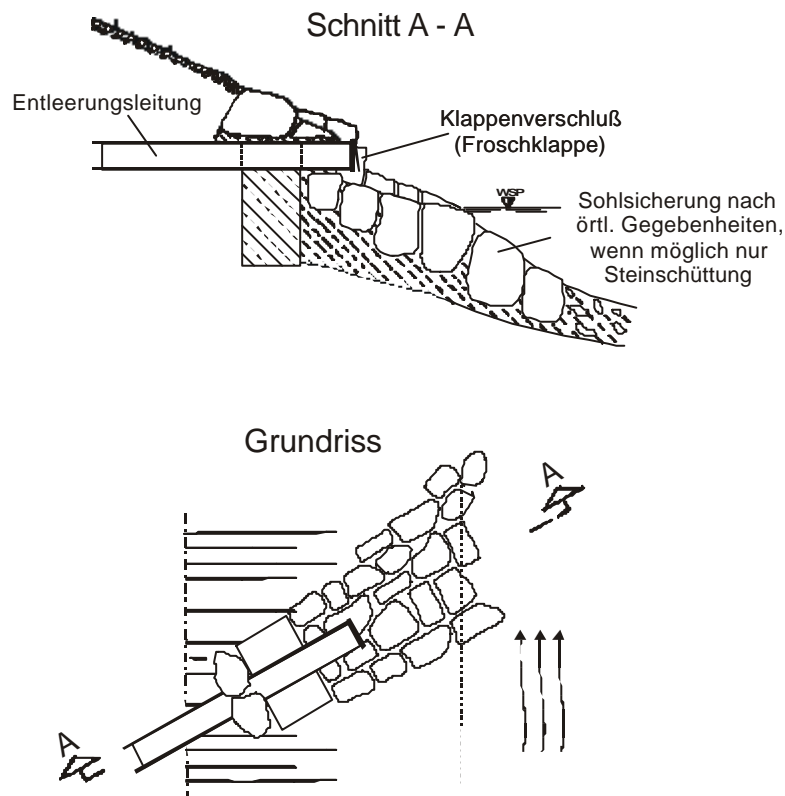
Beispiel eines Auslaufbauwerks für geringe Wassermengen
